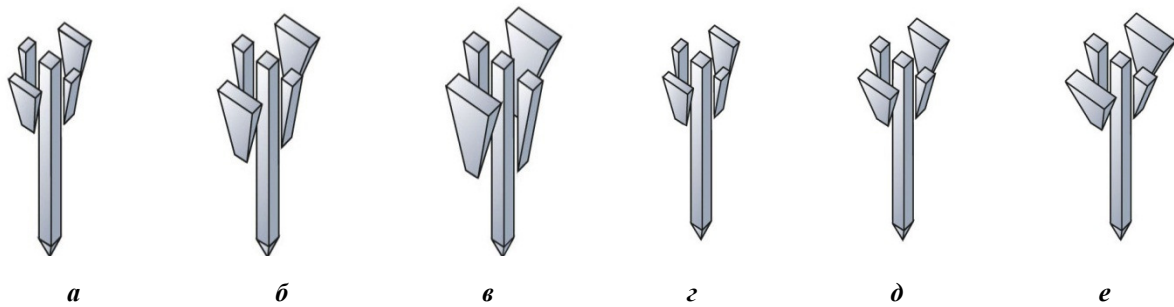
Общий вид конструкций свай с поверхностными уширениями в виде сборных клиньев с увеличением геометрических параметров клина: *a*, *г* – базовая модель конструкции; *б* – с увеличением ширины и длины клина в 1,5 раза; *в* – с увеличением ширины и длины клина в 2,5 раза; *д* – с увеличением только ширины клина у верхнего конца в 1,5 раза; *е* – с увеличением ширины клина в 2,5 раза
